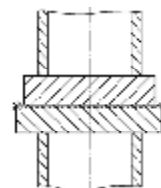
Пластическое деформирование верхнего пояса фундаментной балки (показано штриховой линией)
